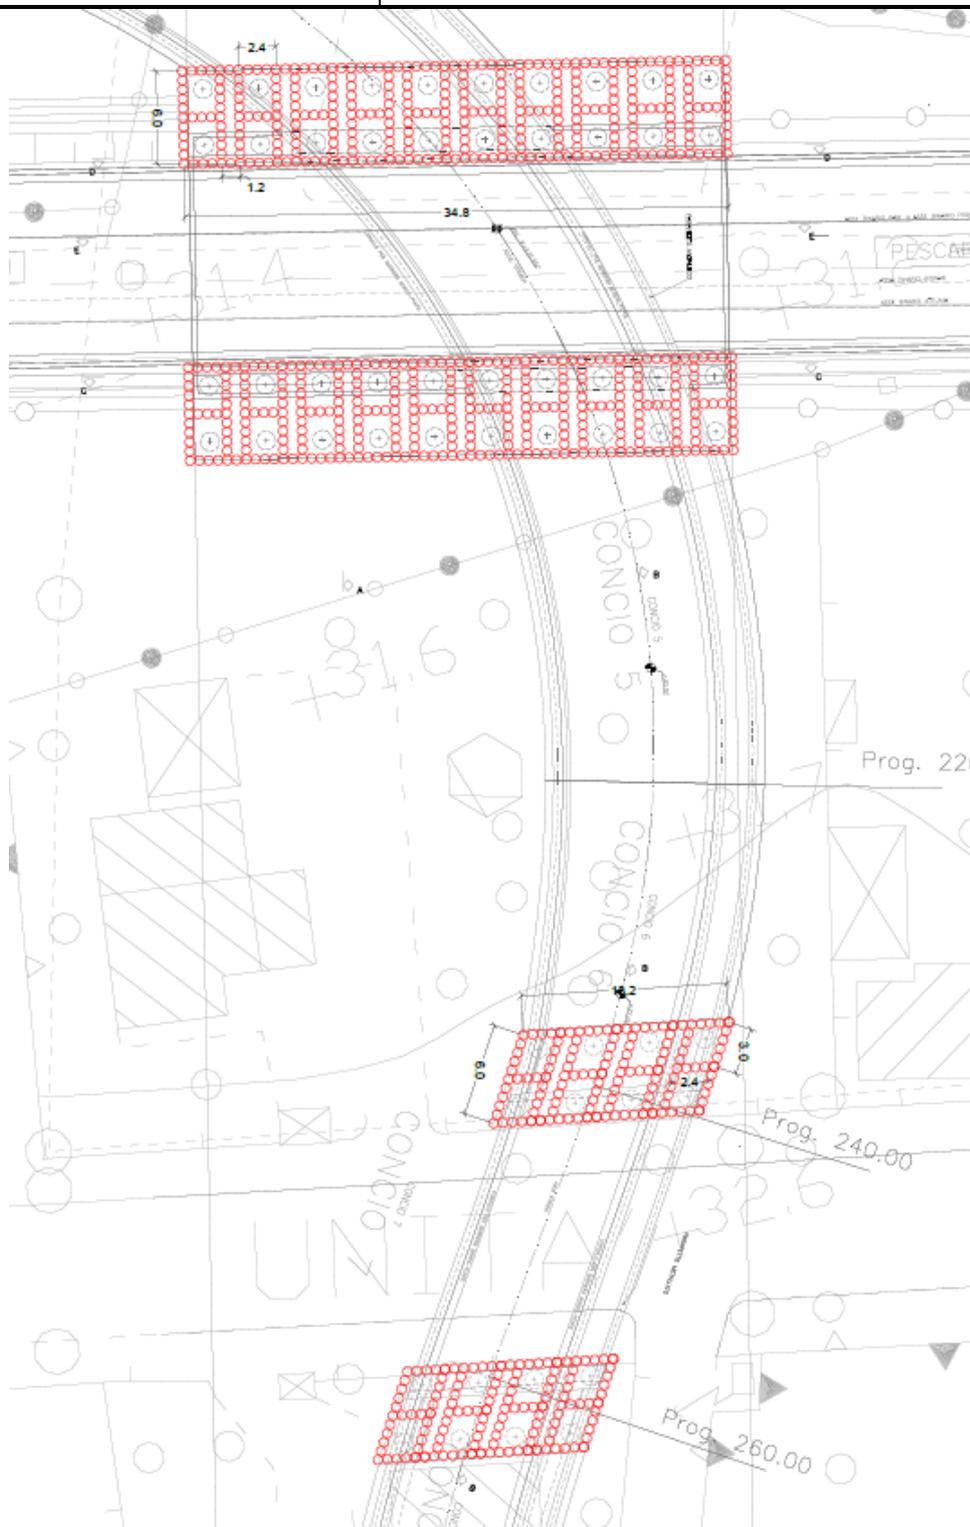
Sezione rappresentativa tratta IV03 – fondazioni su pali - planimetria
